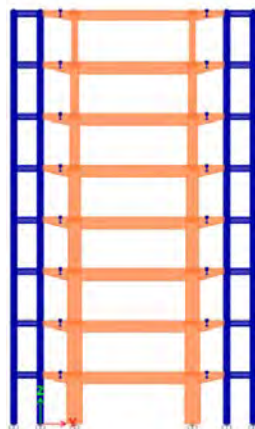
D del edificio reforzado. En color naranja la estructura existente y en azul, la estructura de acero suplementaria de refuerzo.
